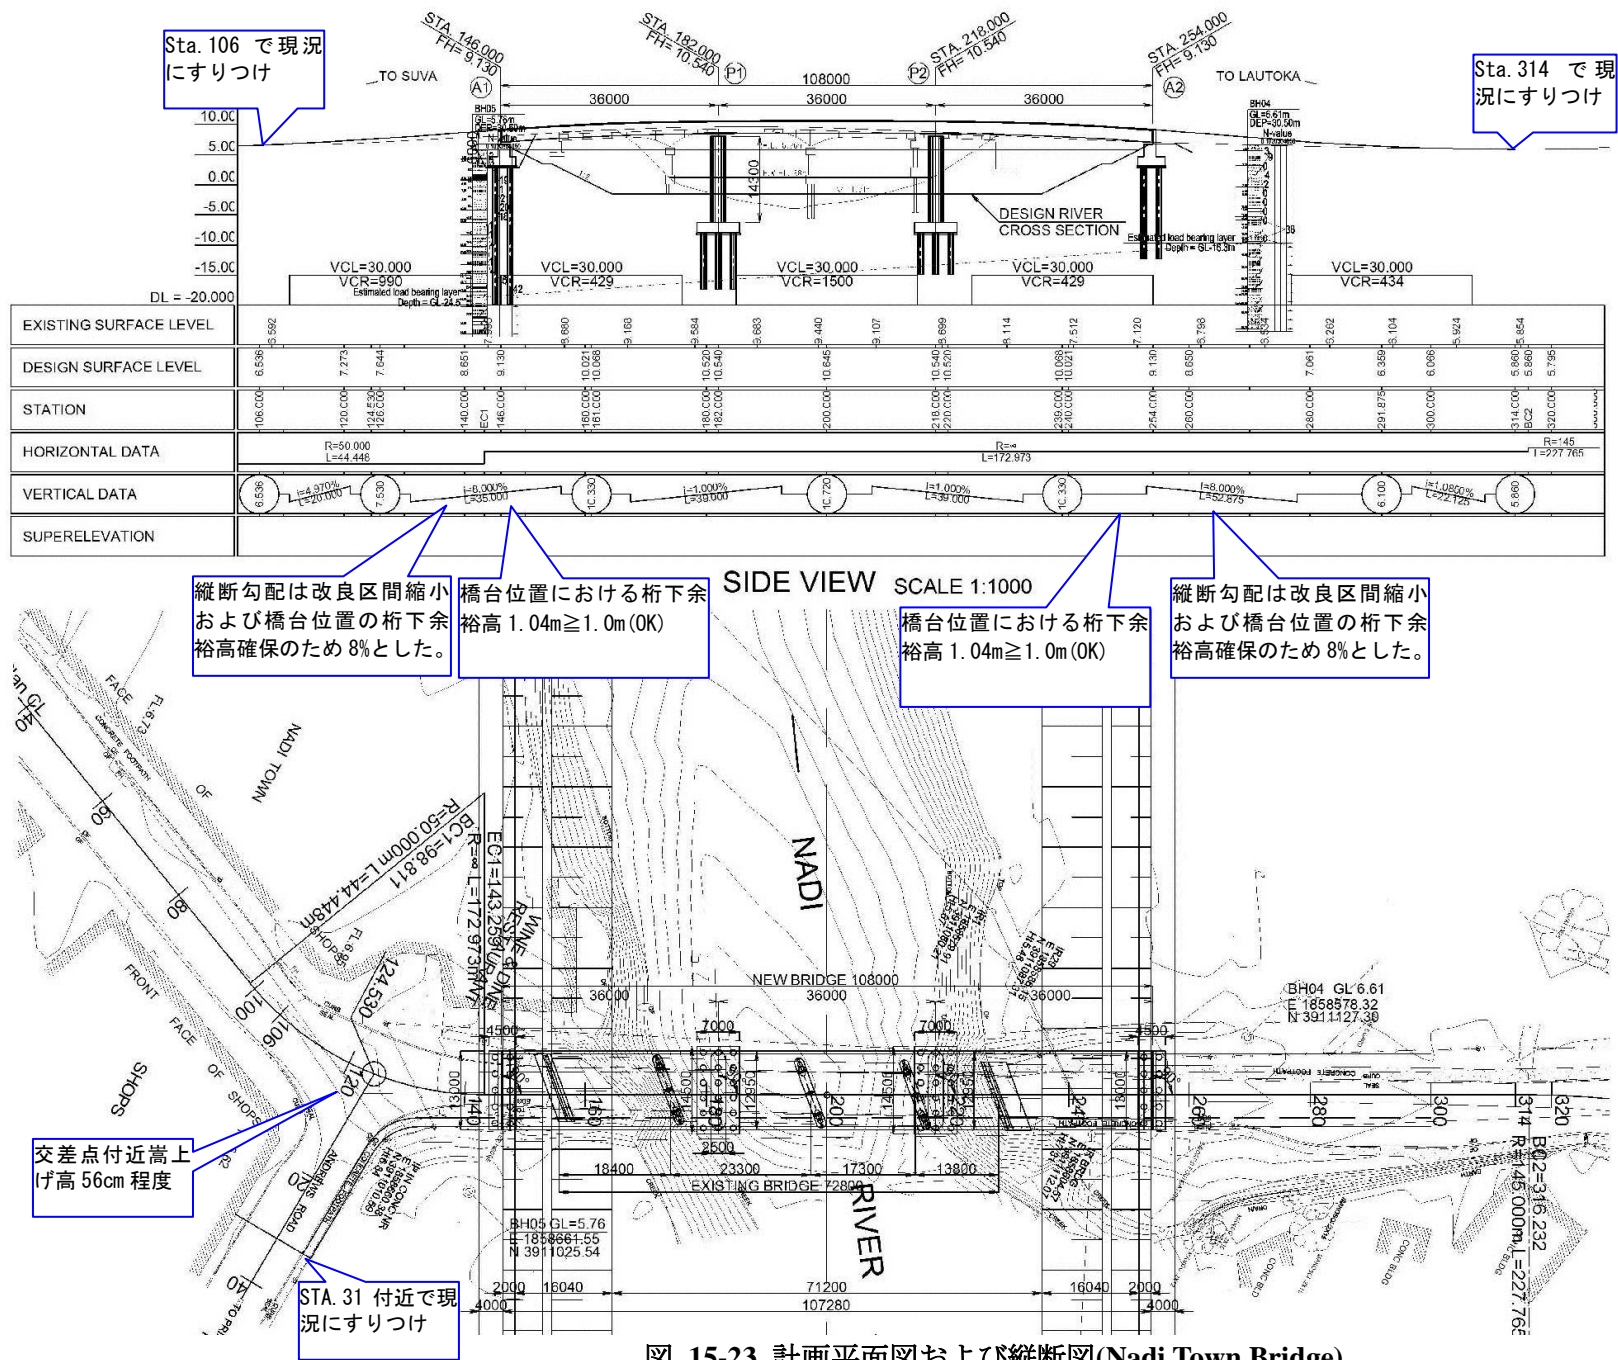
計画平面図および縦断図(Nadi Town Bridge)
